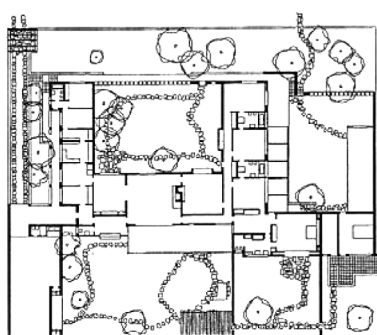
Planta baixa da Casa João Arnstein, projetada por Bernard Rudofsky (1941).
